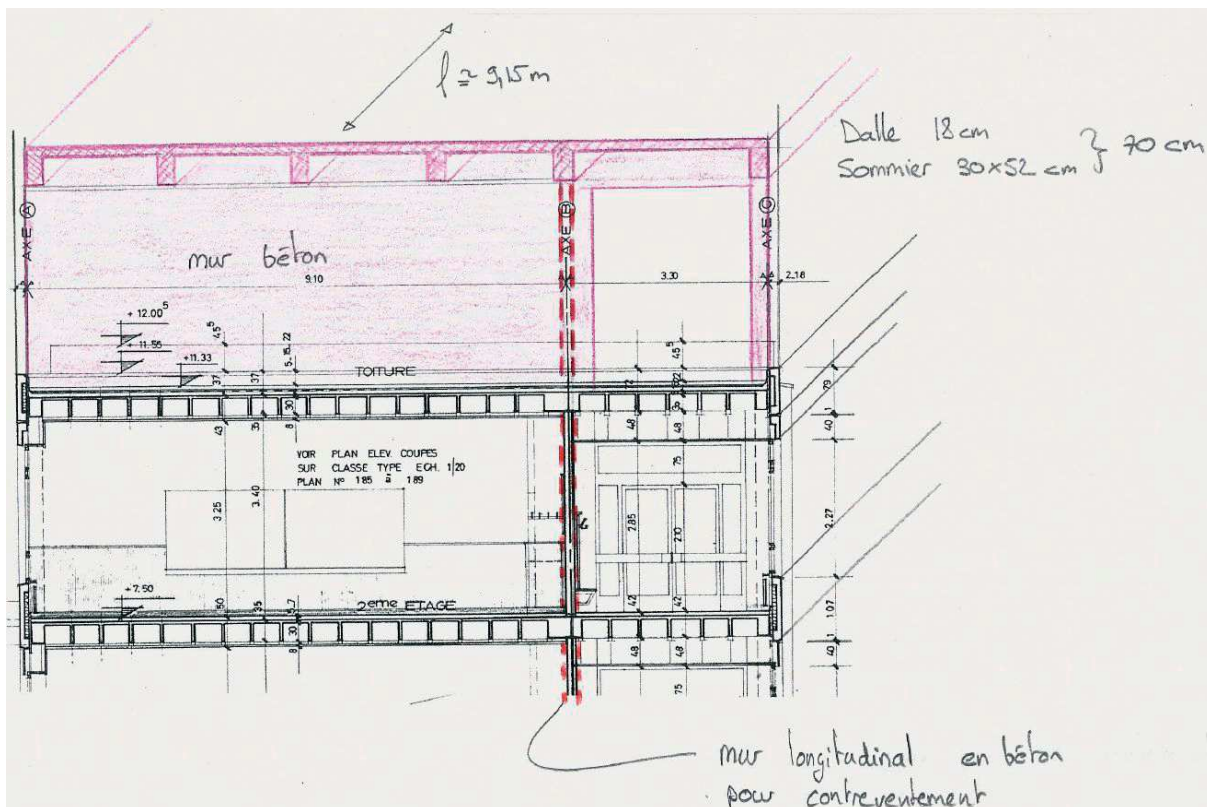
Proposition de nouvelle dalle de toiture en béton pour les ailes Est et Ouest - dalle avec sommiers
